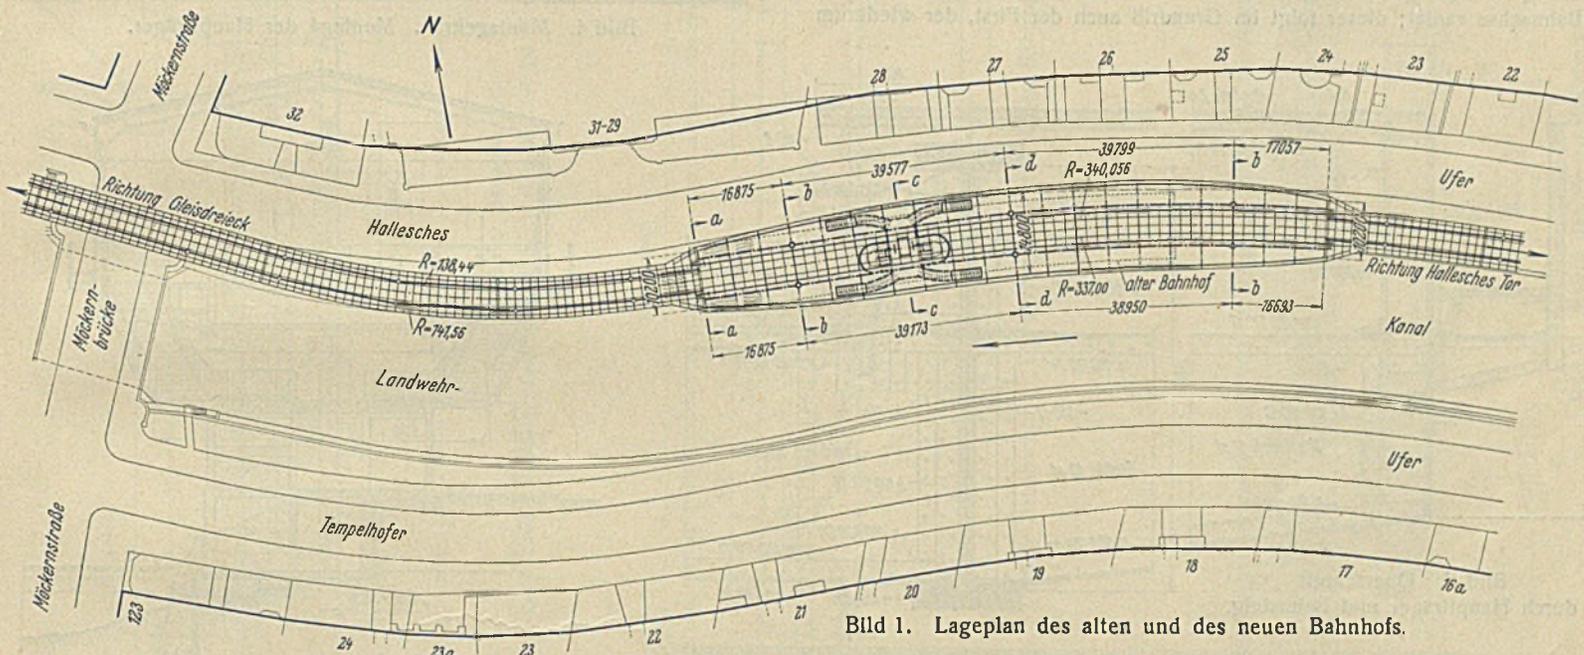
Lageplan des alten und des neuen Bahnhofs.
